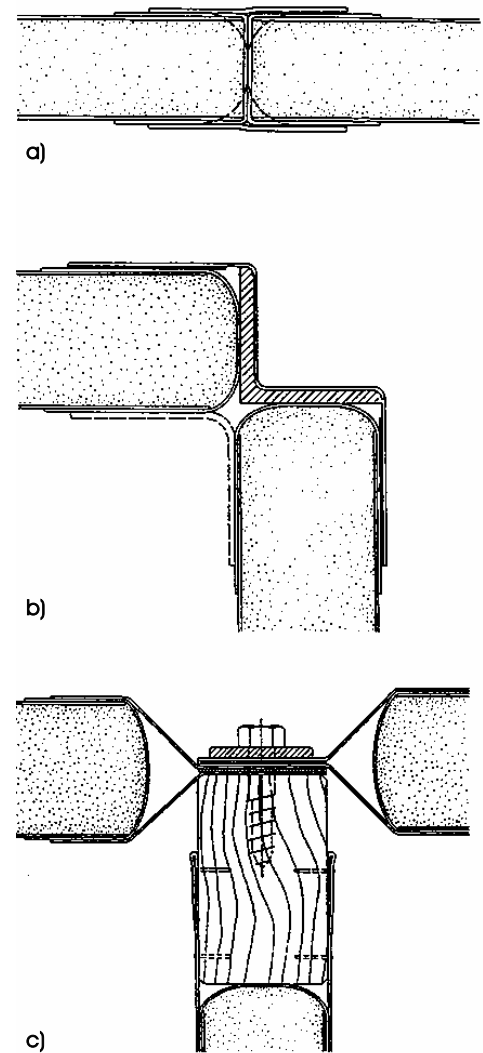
Sistemas de ligação estrutural para construções de painéis sandwich de membrana (Bubner 1997)
